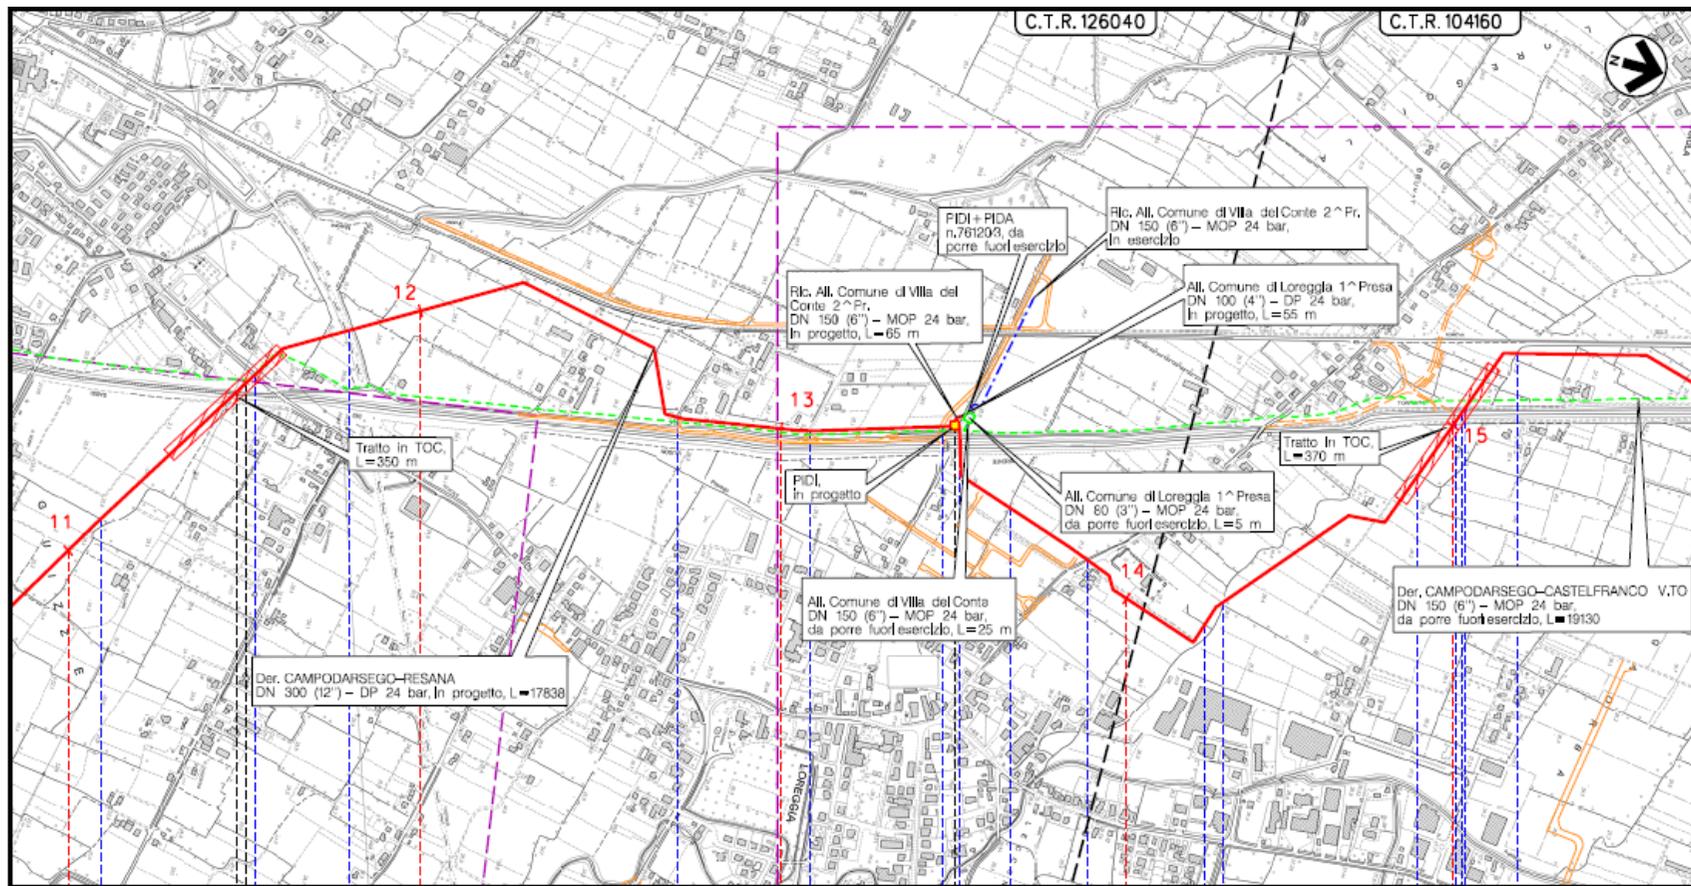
1^ TRATTO - Stralcio planimetria CTR con localizzazione dell'area di intervento
